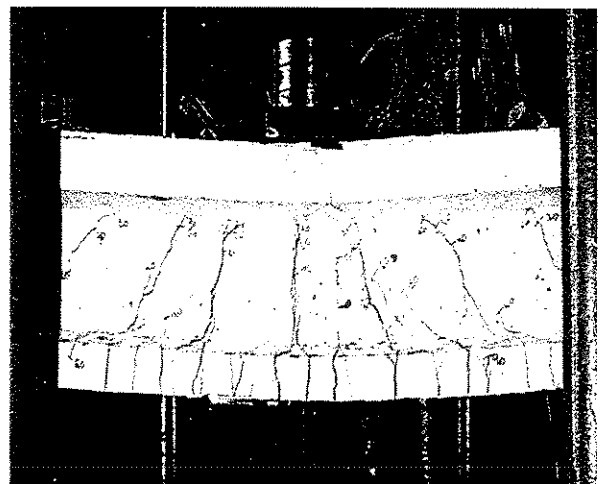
Panorama final de fissuração das vigas HC ensaiadas
